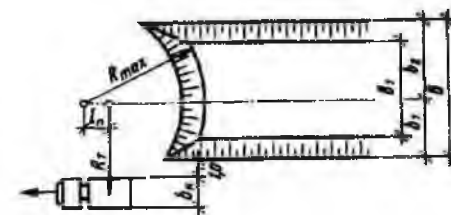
Схема разработки грунта экскаватором обратной лопатой при торцовой проходке
